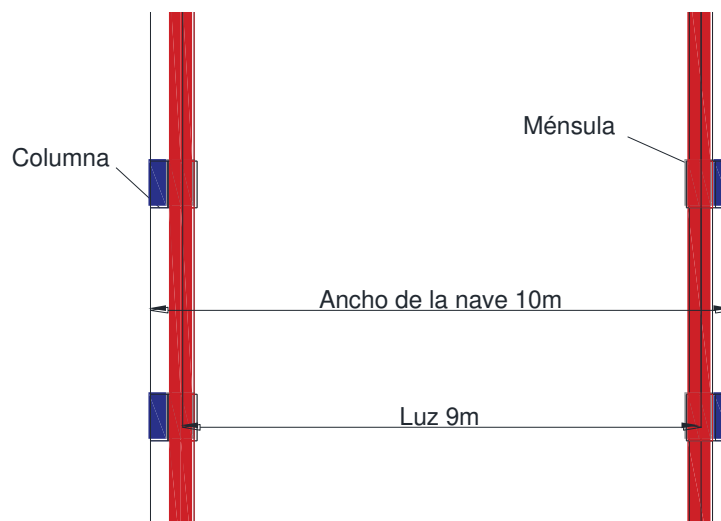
Distancia entre columnas de Enox Ingeniería
